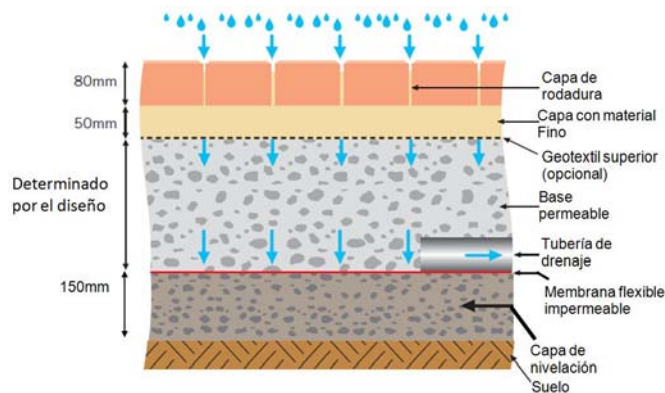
Sección transversal de un Pavimento Permeable (Adaptado de: Interpave, 2008)
